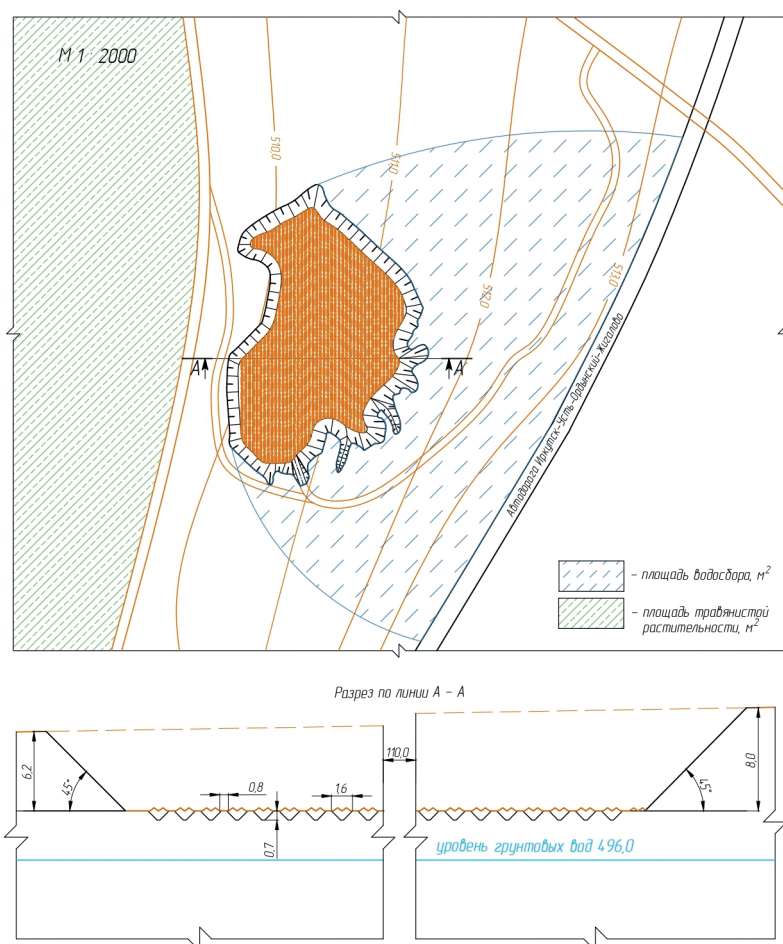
Общий вид карьера с бороздами: схема карьера (а); разрез по линии А-А (б)
